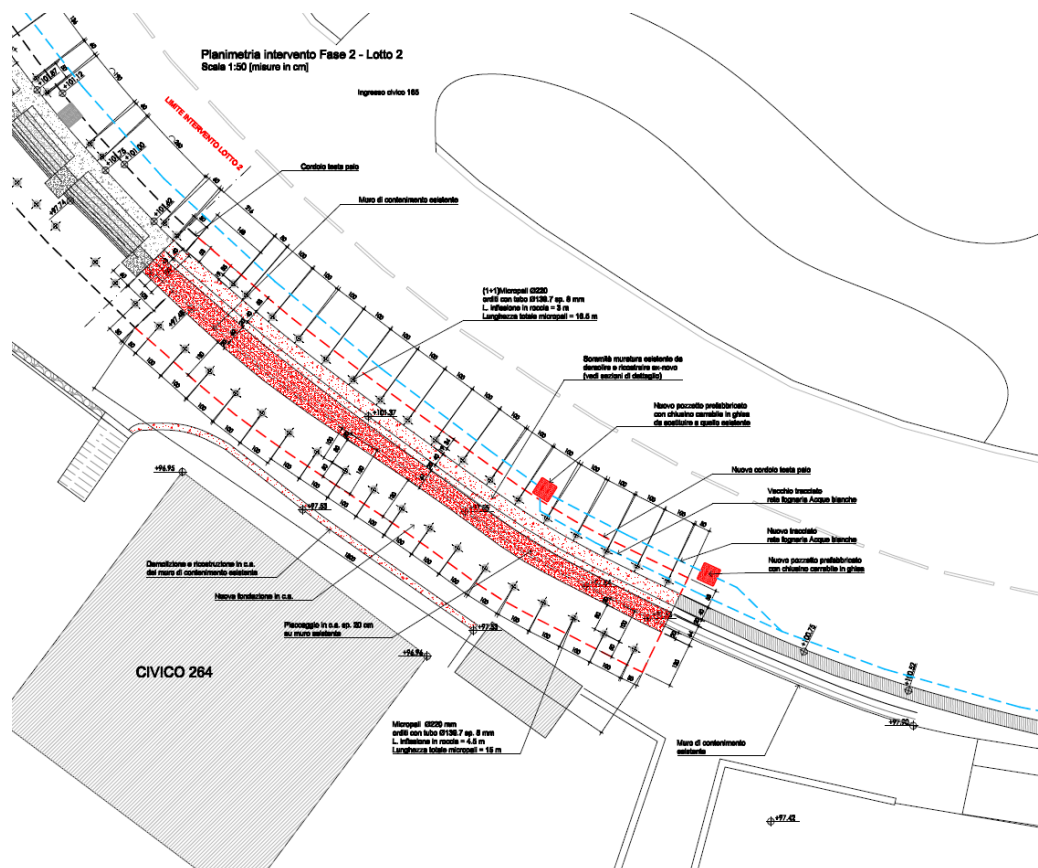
Planimetria intervento Lotto 2 – Fase 2
